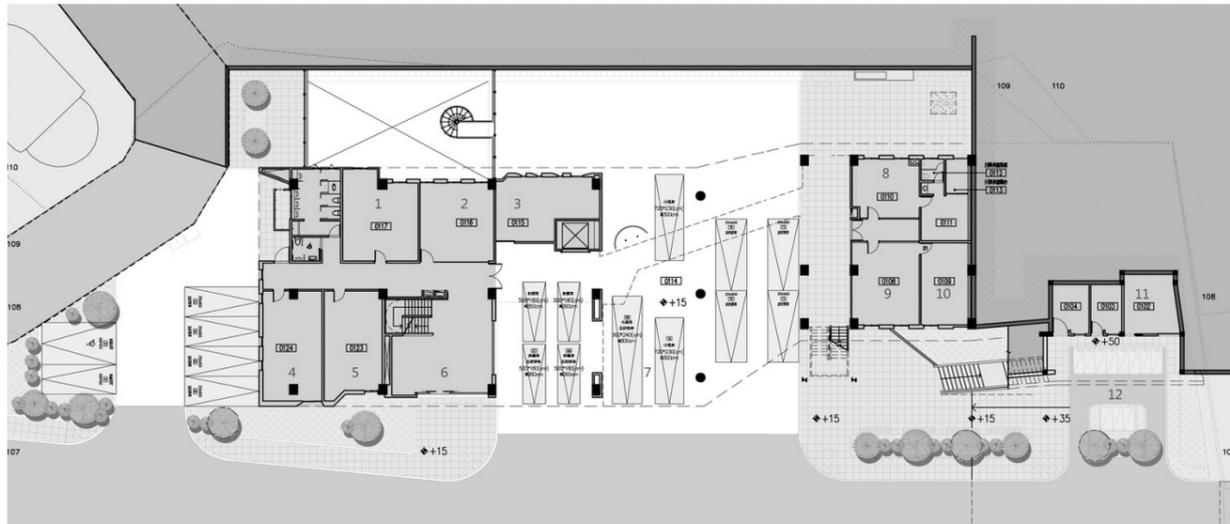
Planta Baja estación de bomberos DA-YO. Fuente: K-Architect
